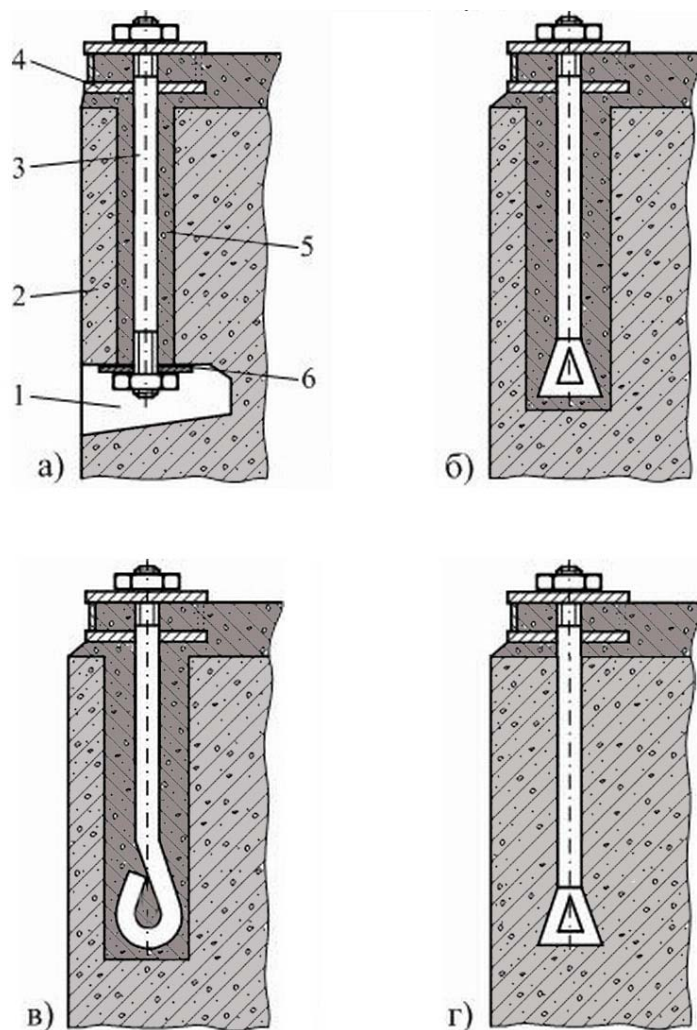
Установлення анкерних болтів: 1 – ніша; 2 – фундамент; 3 – анкерний болт; 4 – фундаментна плита; 5 – колодязь; 6 – анкерна плитка
